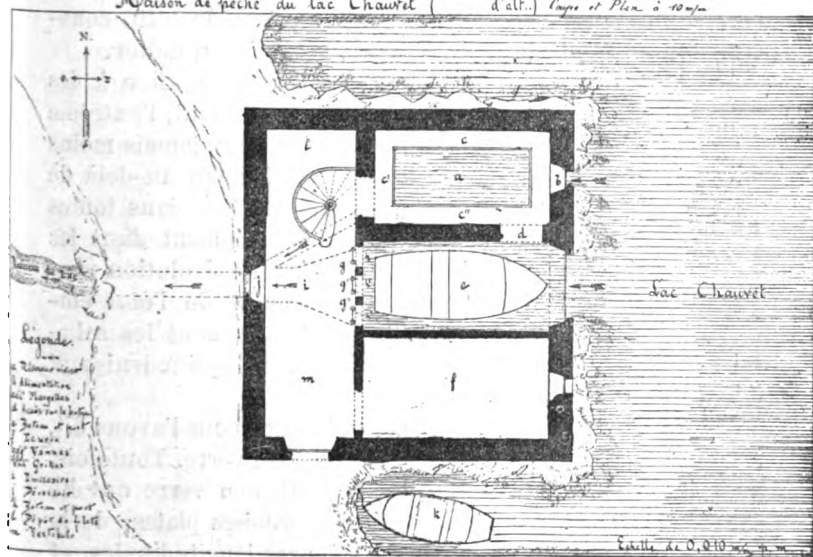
Lac Chauvet. — Plan de la maison de pêche.
